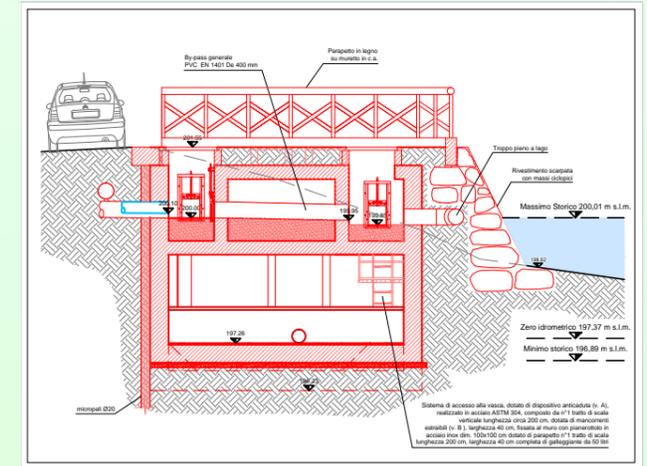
Stazione di sollevamento S.S.6 - Sezione
